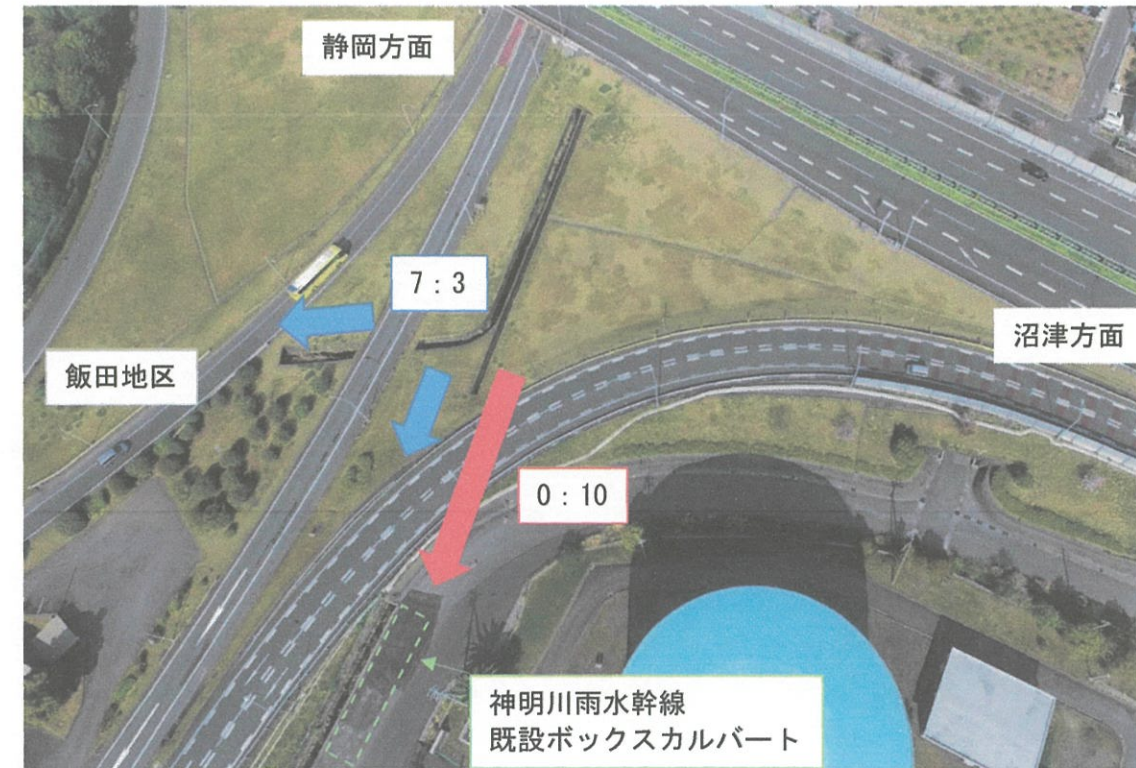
青線：施工前の排水路 赤線：施工後の排水路
